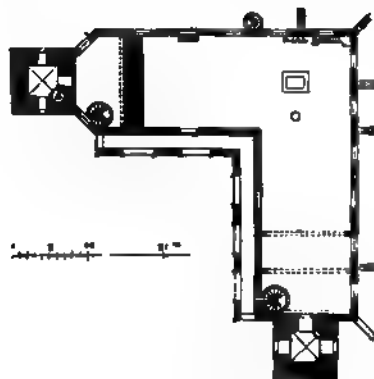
Grundriss der Kirche zu Freudenstadt
